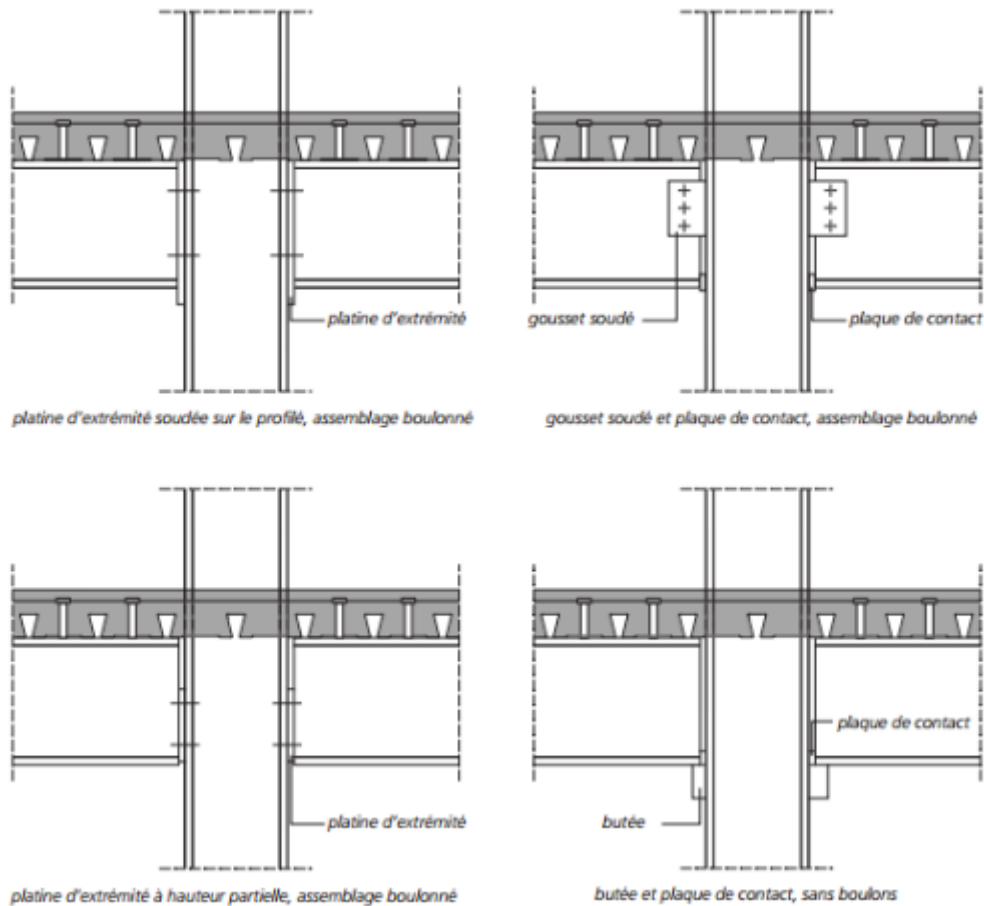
quelques exemples d'assemblages poutre/ poteau en construction mixte
